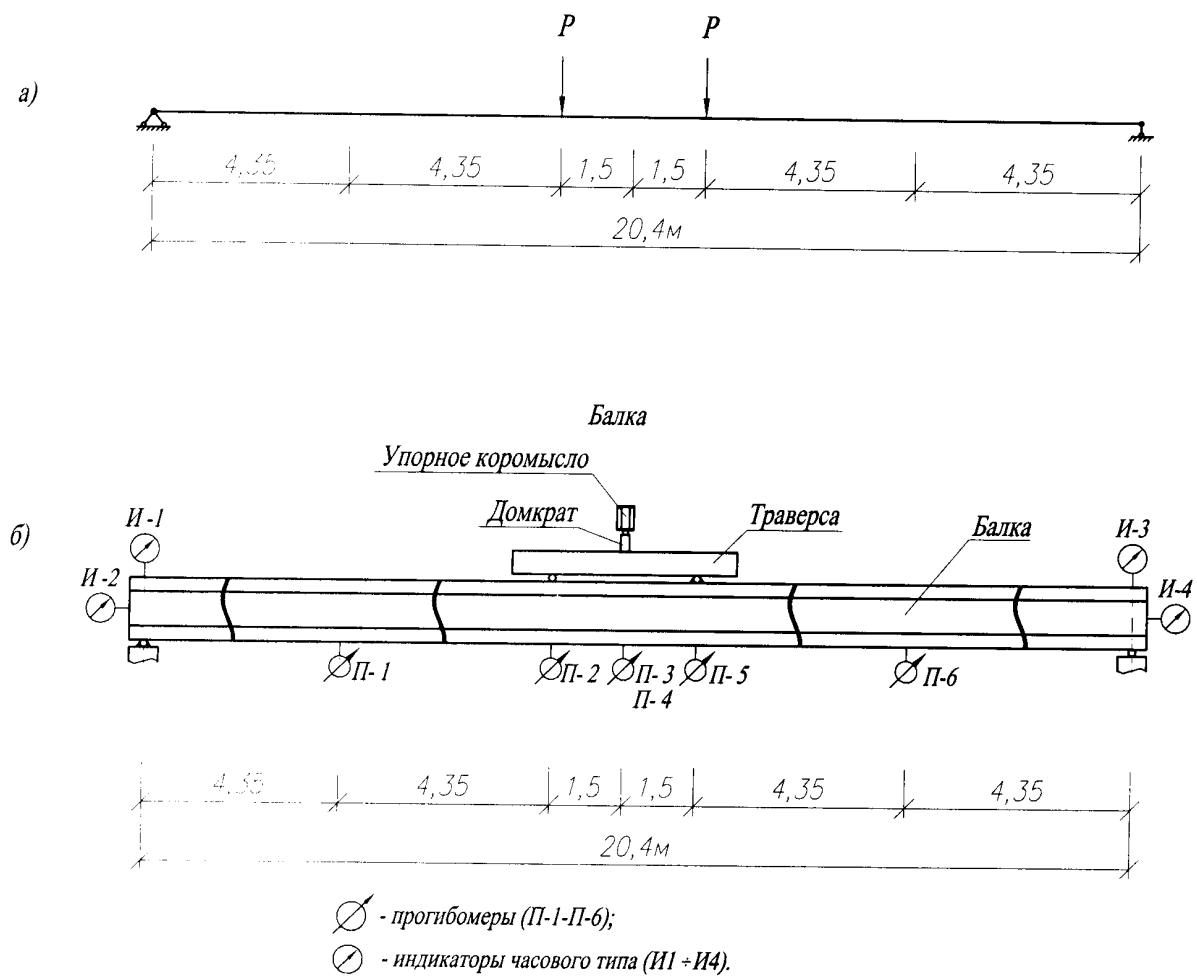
Расчетная схема испытаний балки ВТК – 21У (а) и схема балки ВТК – 21У с расположением на ней загрузочных устройств и механических приборов (б)
